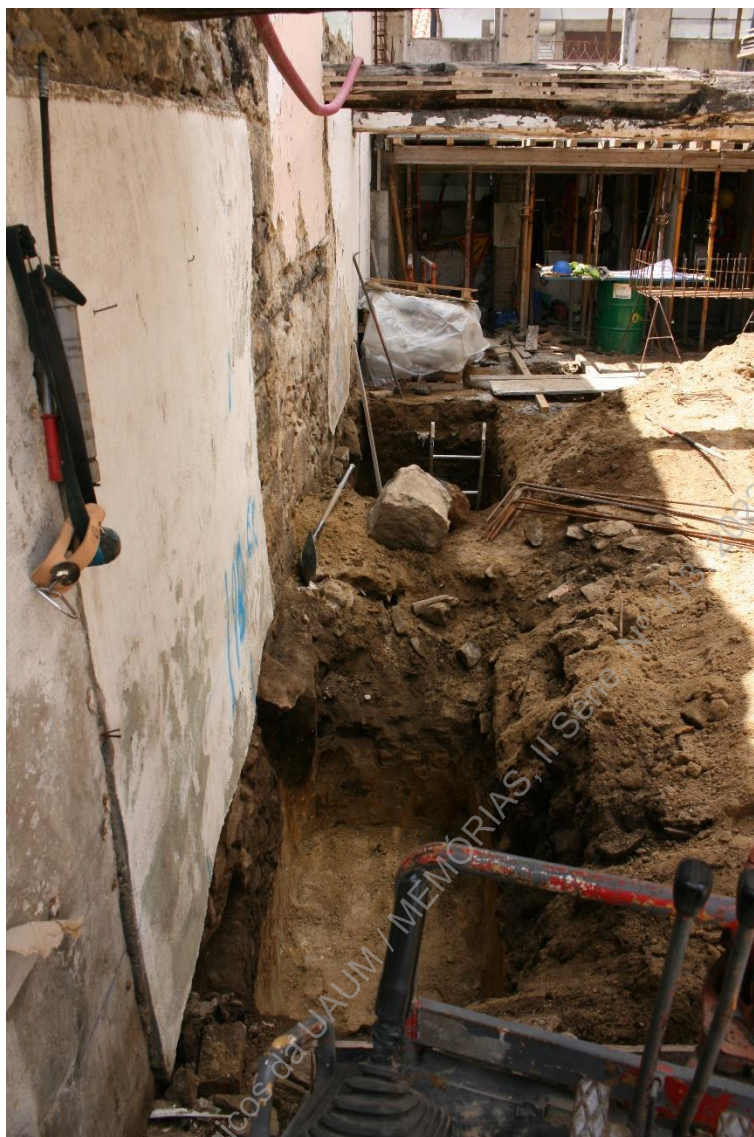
(IMG_5214) – Aspeto valas para sapatas na zona sul.
